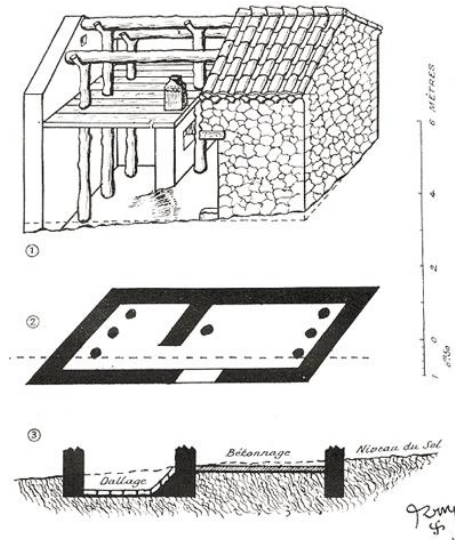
Schémas système de poutres et piliers.(Source: reservall)
